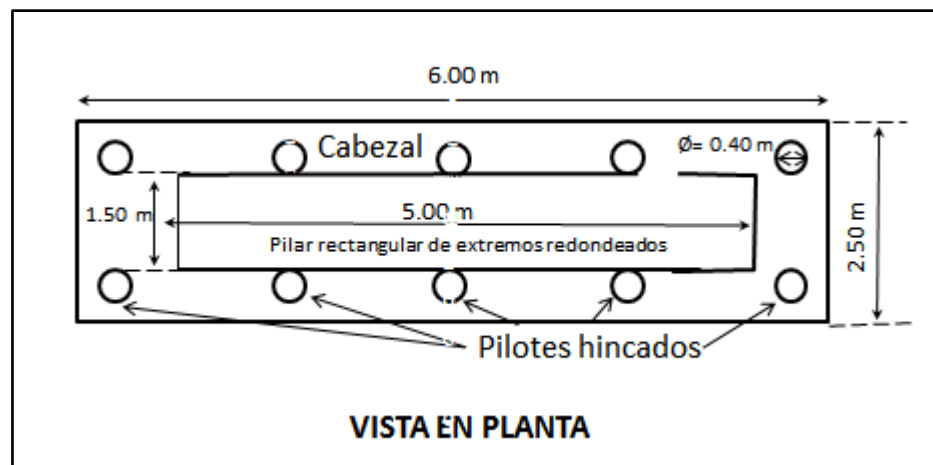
Vista en planta de sistema de pilas de fundación del puente Las Flores sobre el río Santa Bárbara. Croquis sin escala.
